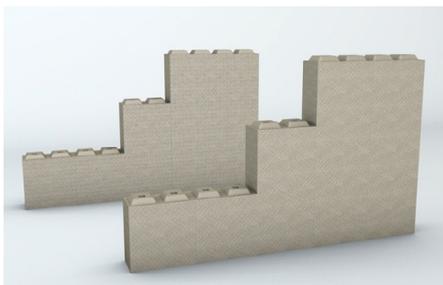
| Alternative zum herkömmlichen Beton: Polymerbetonsteine, die sich stapeln lassen
